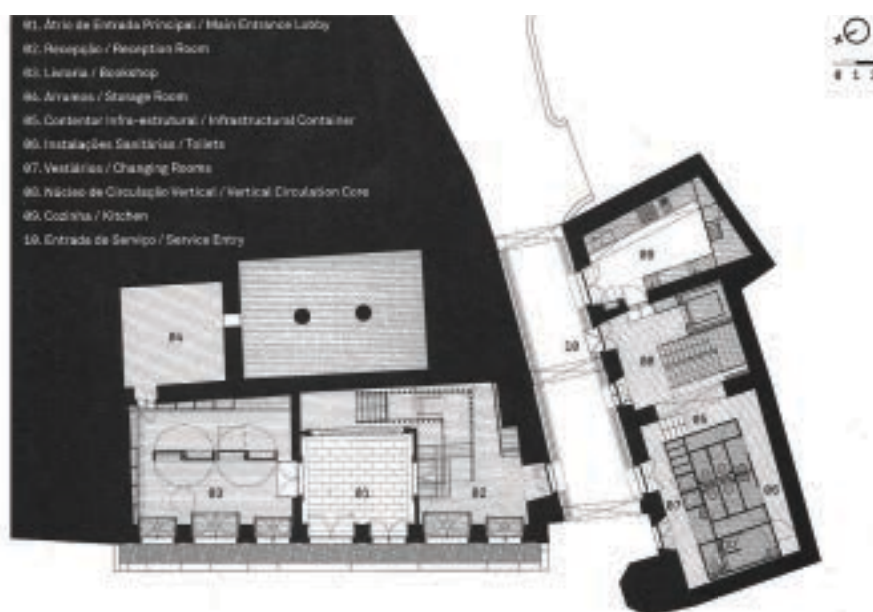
Planta do piso térreo. (Ribeiro, 2013a, p. 129)
